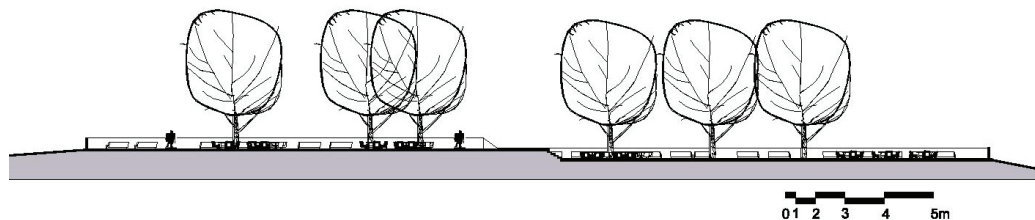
Corte do projeto de intervenção da Praça do Céu
